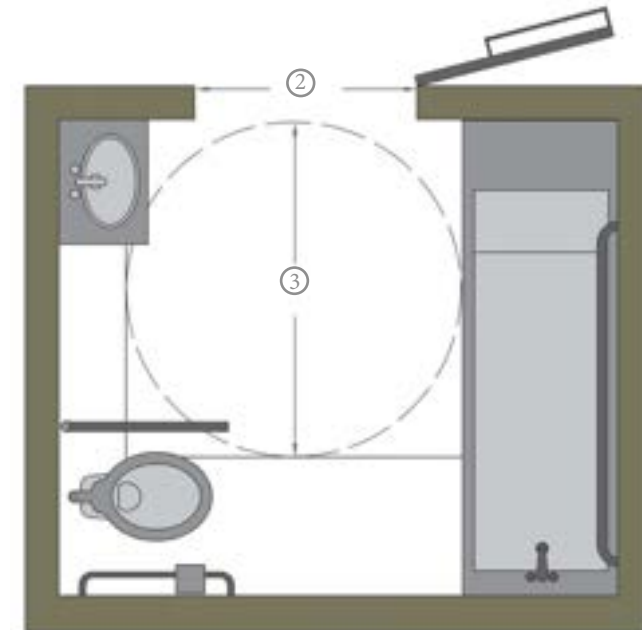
2 Baño con inodoro en esquina con tina - Planta
